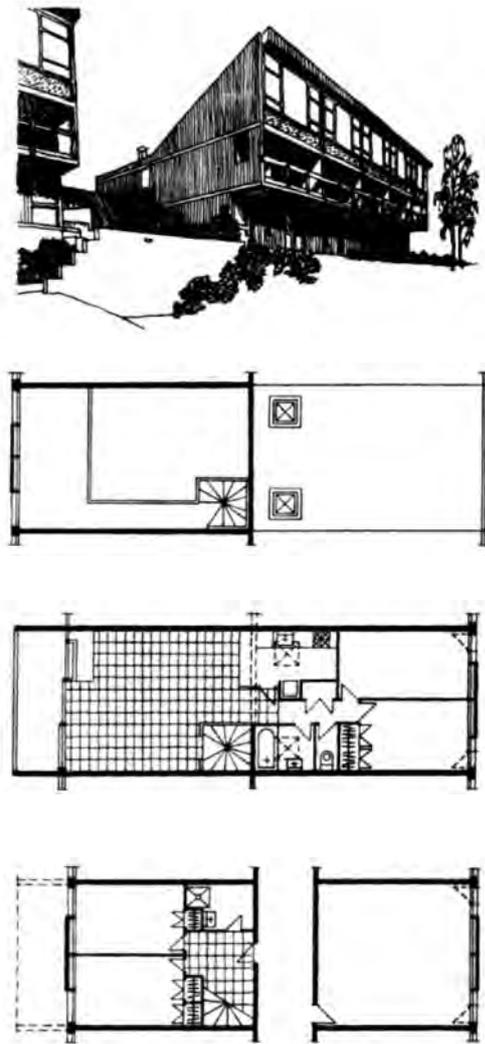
Блокированный пятиквартирный жилой дом с общими комнатами, решенными в два яруса — нижний и антресольный (Франция). Общий вид, планы этажей (антресольный, второй, первый)
